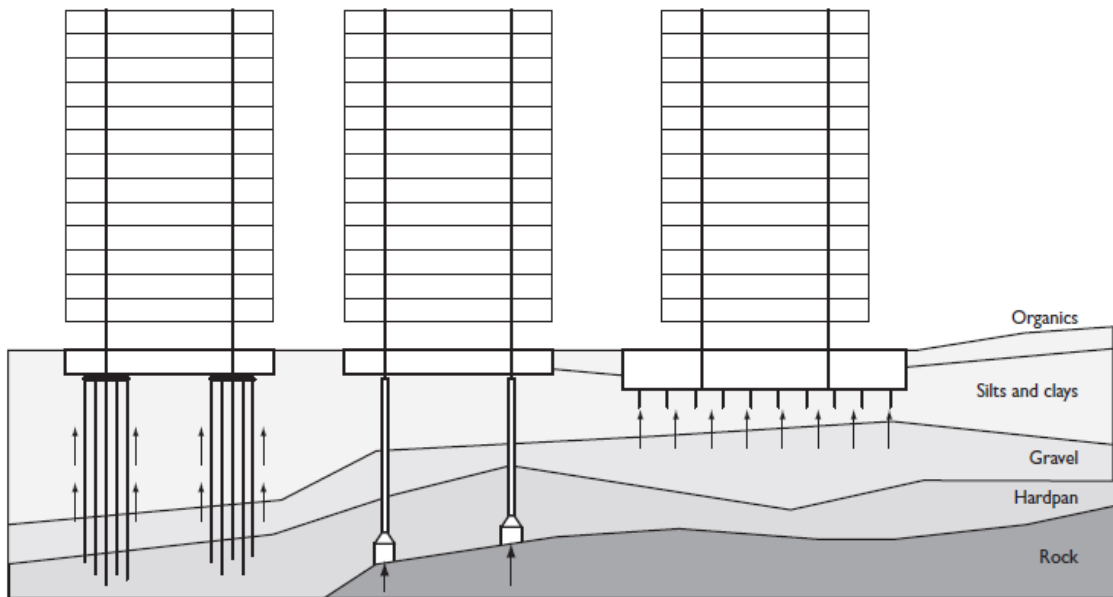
Keajaiban atau kekeliruan dalam desain pondasi?
